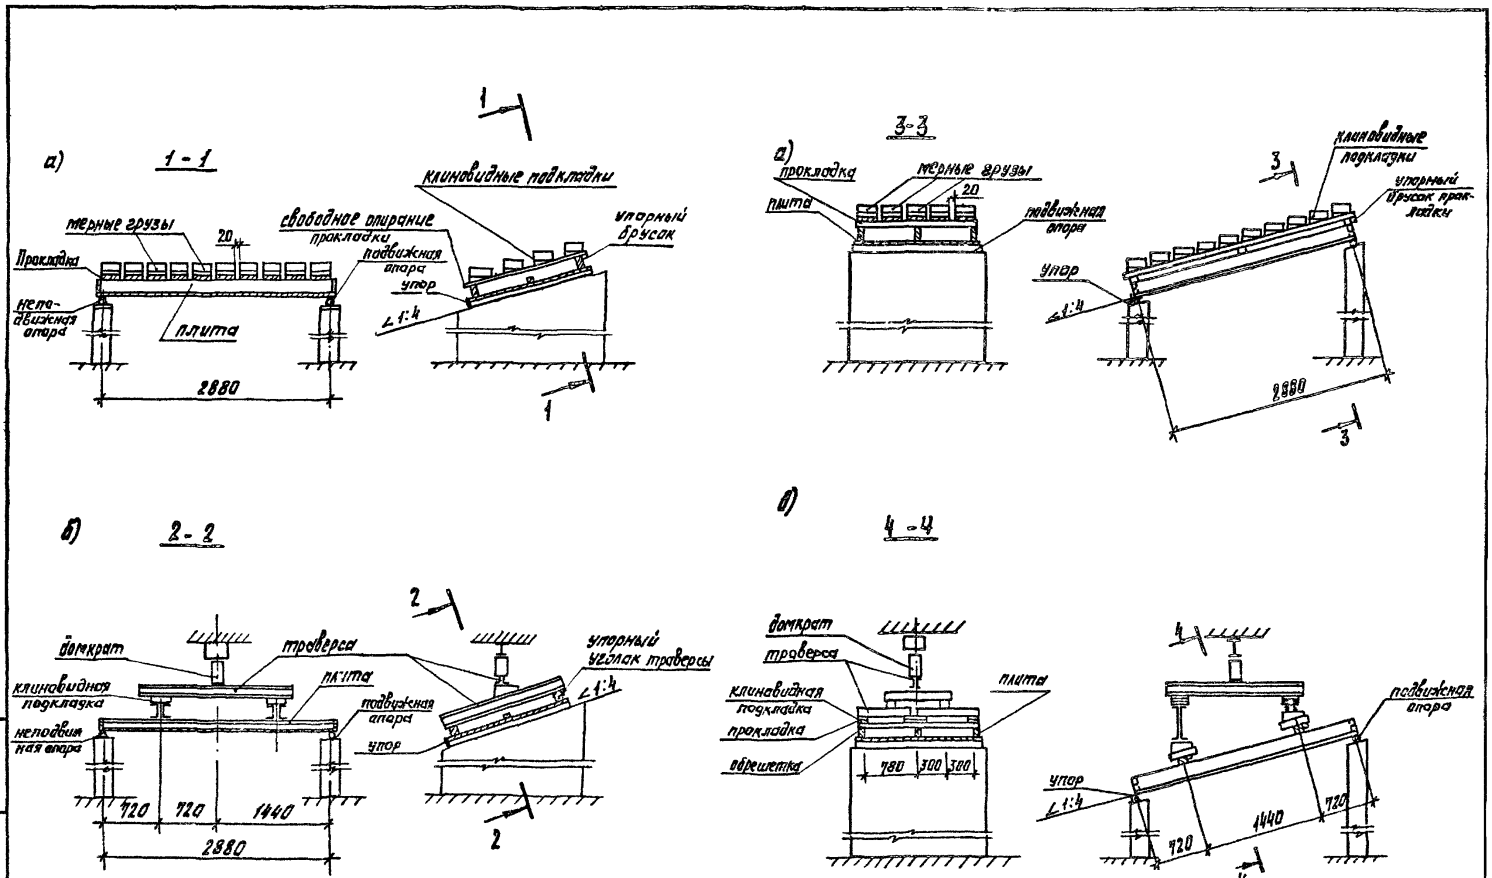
Схемы испытаний плит покрытий, уложенных по ступенчатой конструкции
